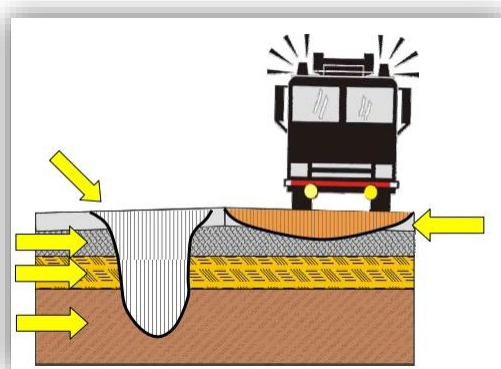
Bulbo de Tensões pavimento flexível x rígido.
